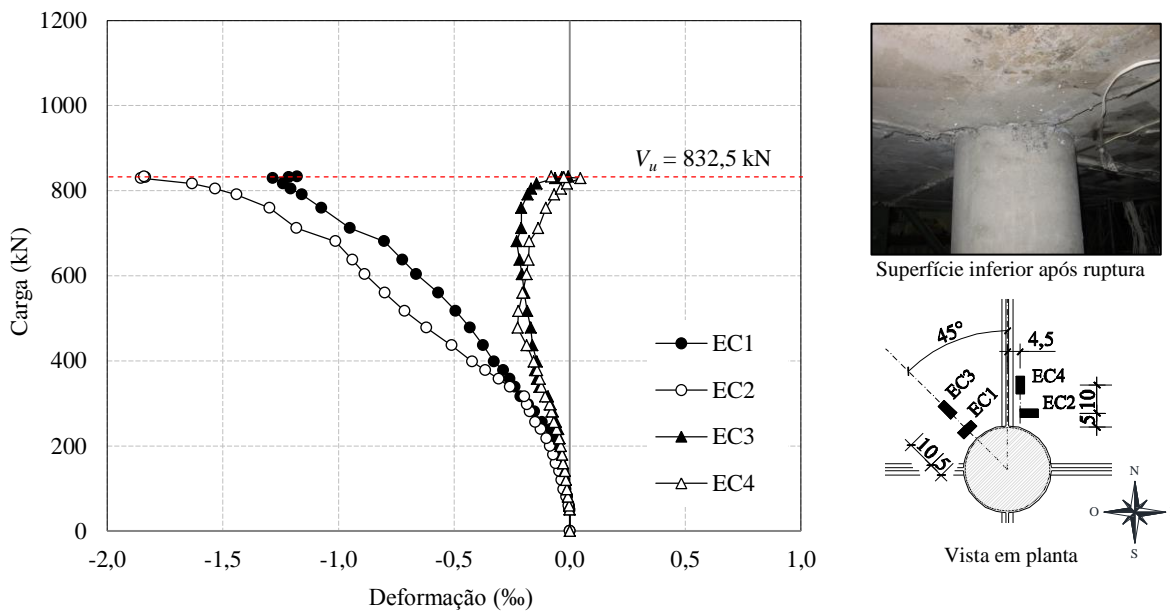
Deformações na superfície do concreto da laje BD2
